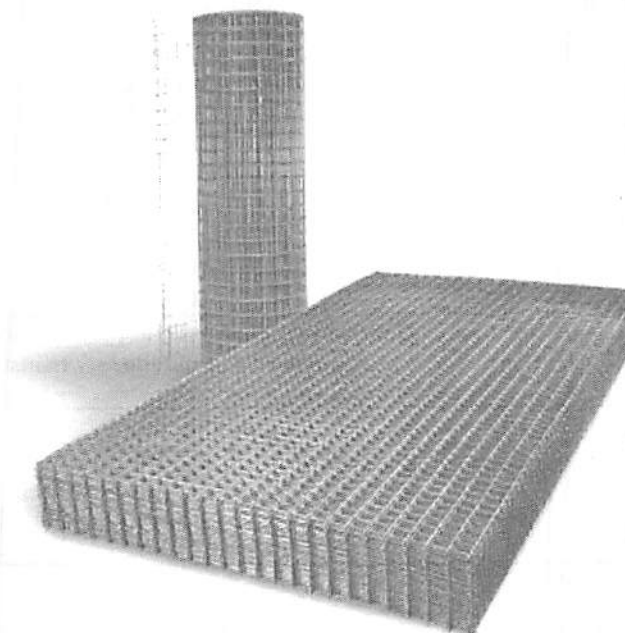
Telas soldadas: rolo e painéis
